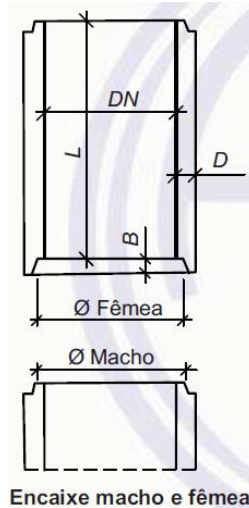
Dimensões do Tubo de Concreto Tipo Macho e Fêmea
